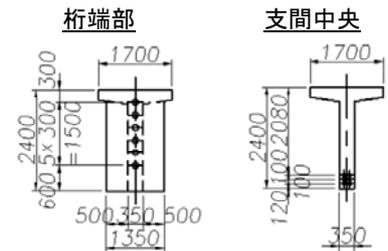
PRCT 桁側面図および鋼材配置図(単位:mm)
